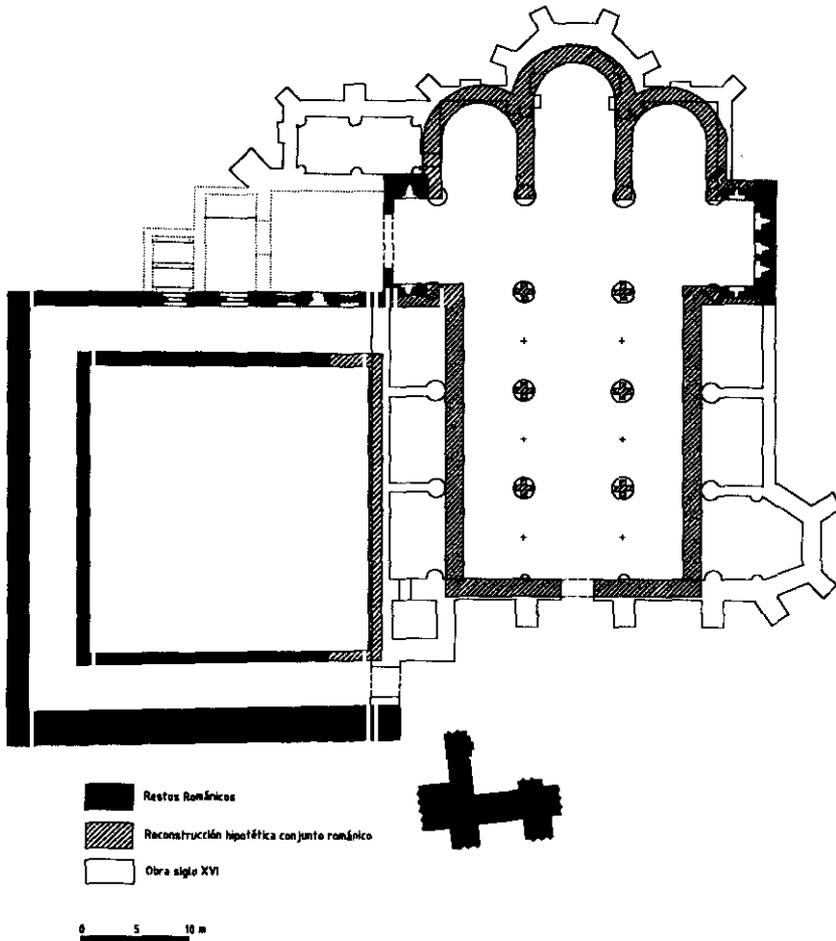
Hipótesis de reconstrucción II sobre planta actual.
